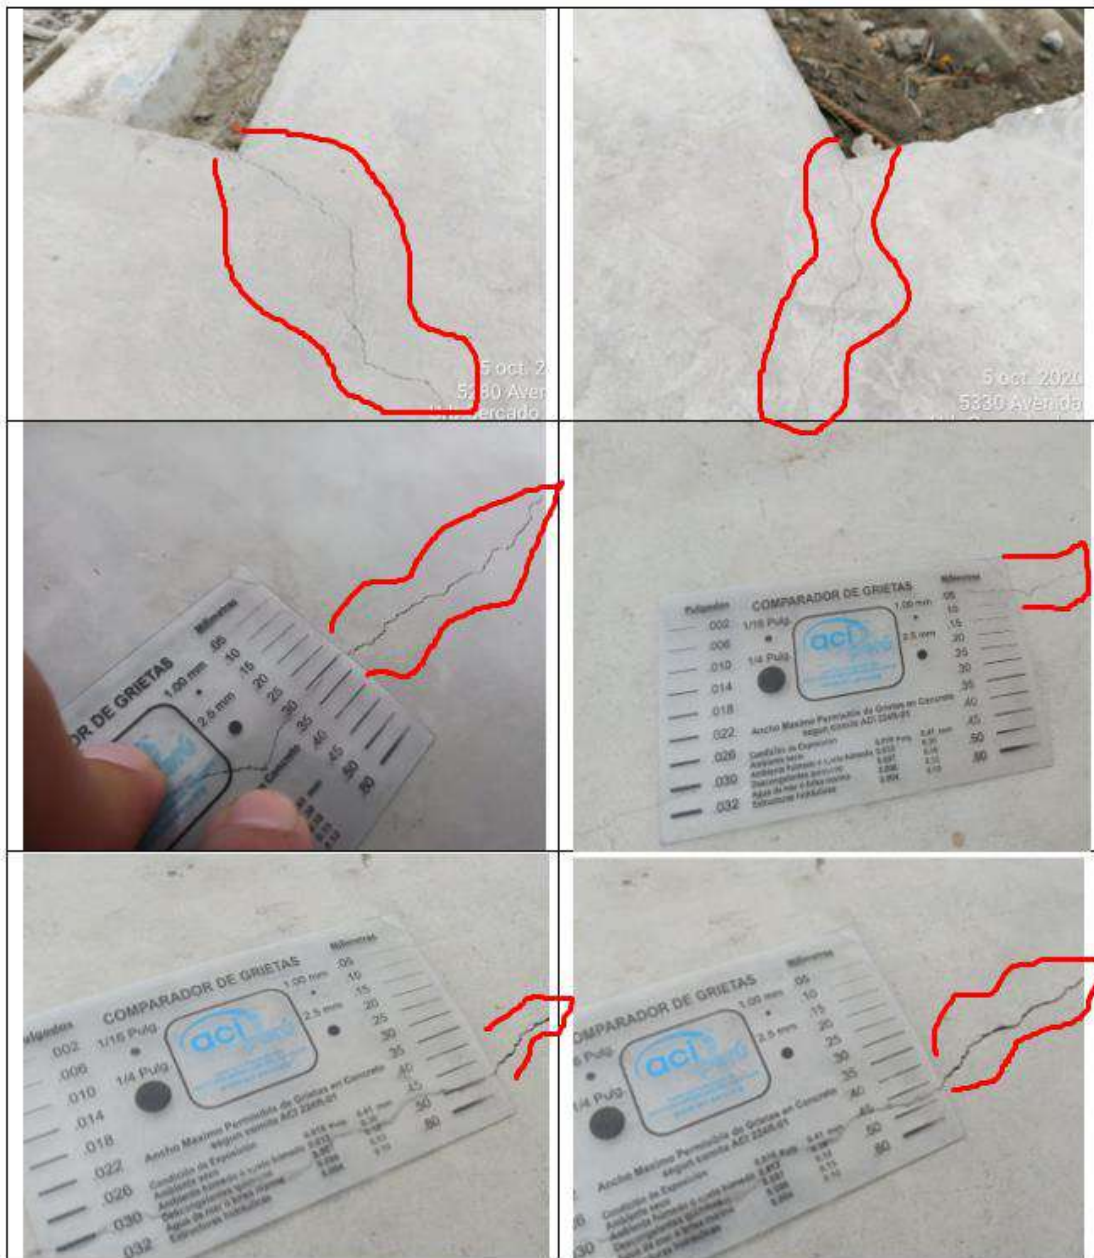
Registro fotográfico de la inspección y medición de fisuras encontradas en las losas
